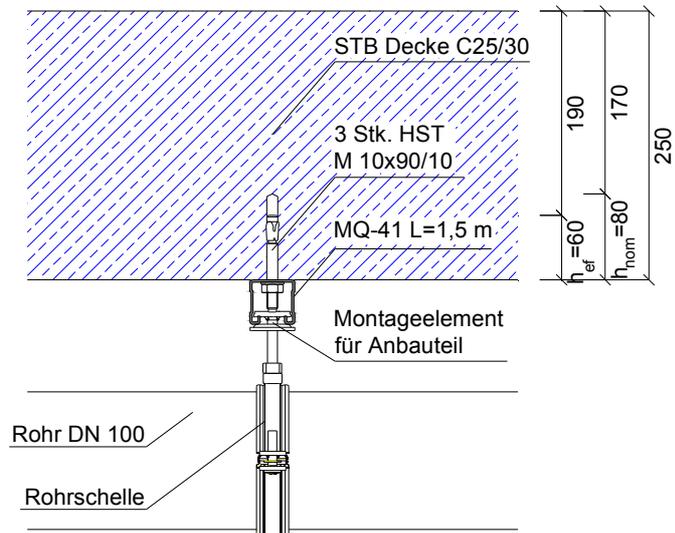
Anschlussdetail H1 Dübel Variante 2 (Maße in mm)
